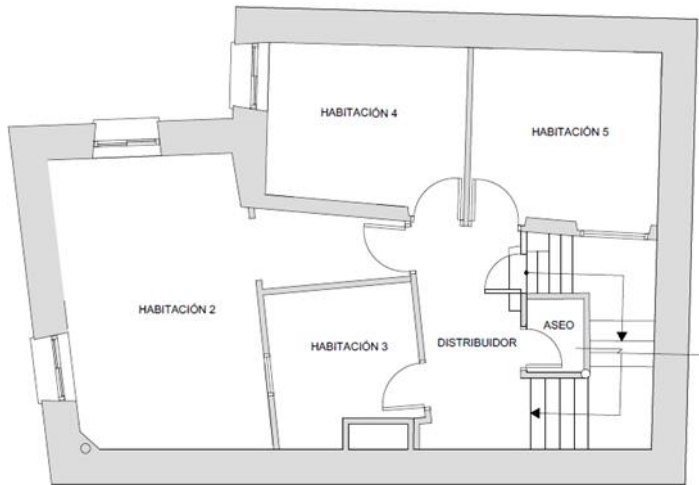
Plano de distribución de planta primera. Fuente: Autor.
